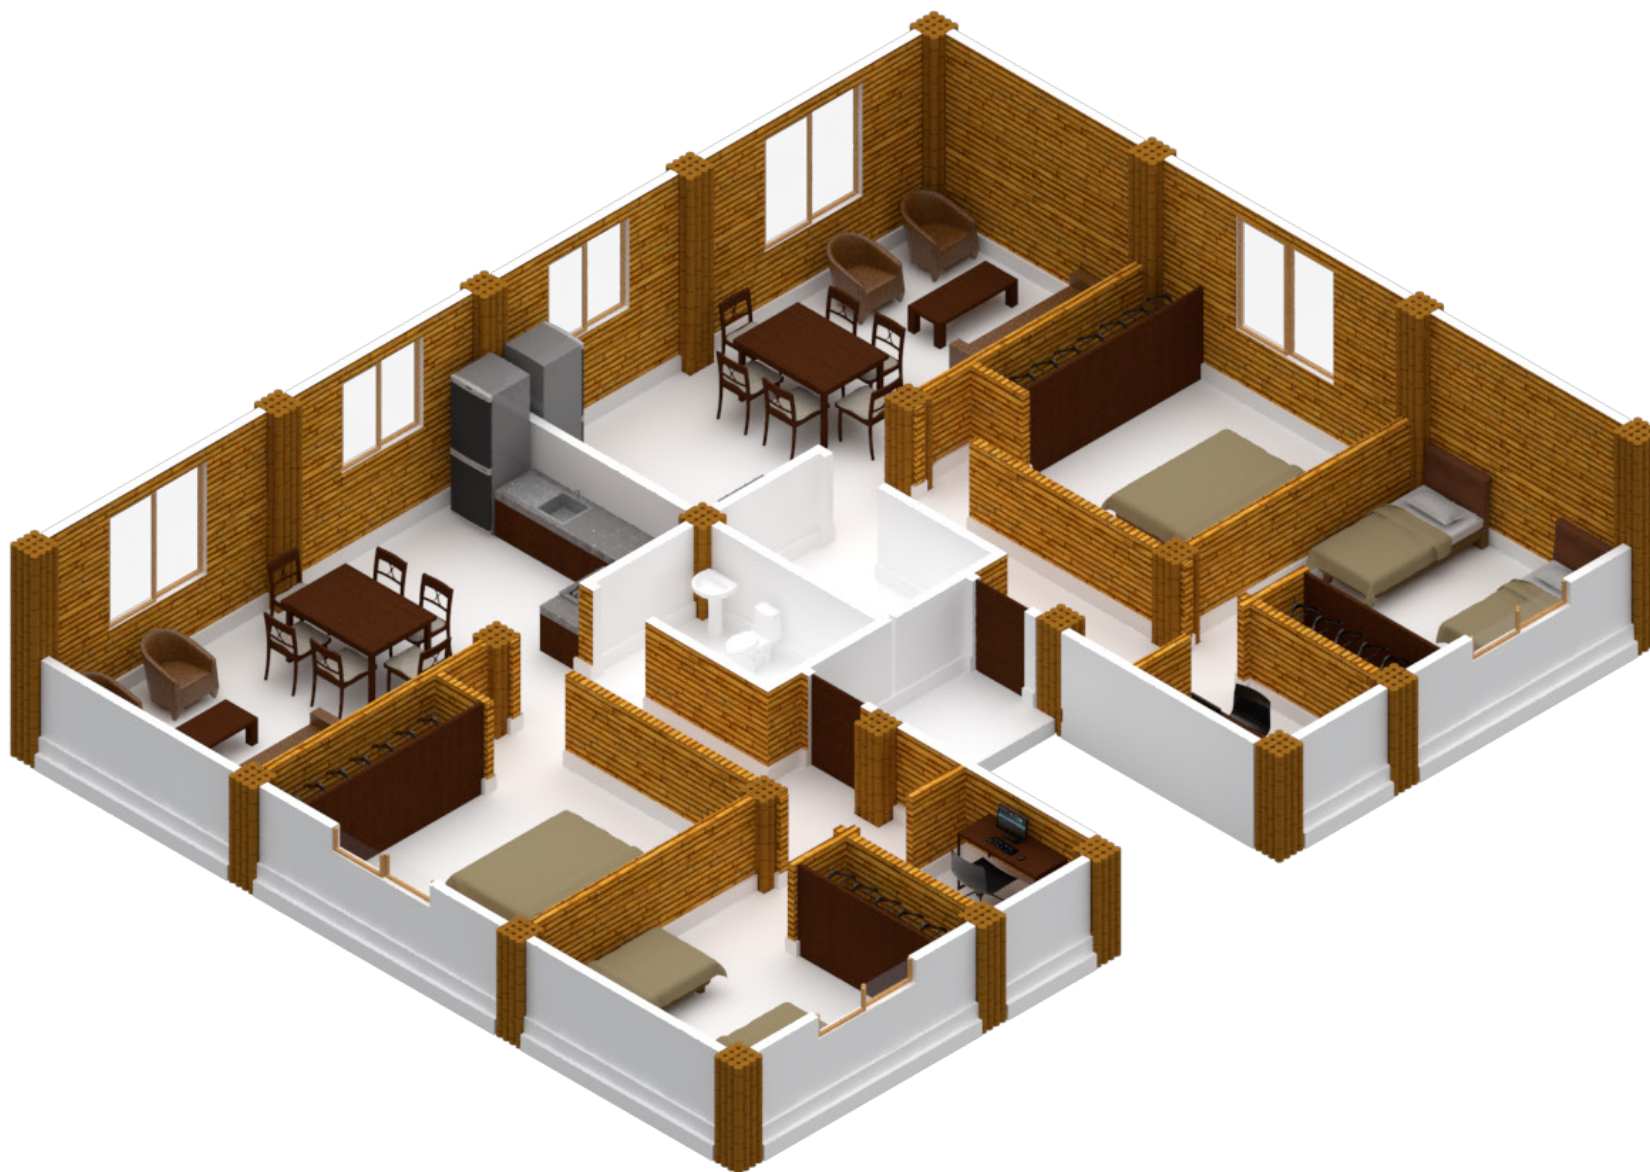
Axonometría vivienda tipo 3 planta alta 2
